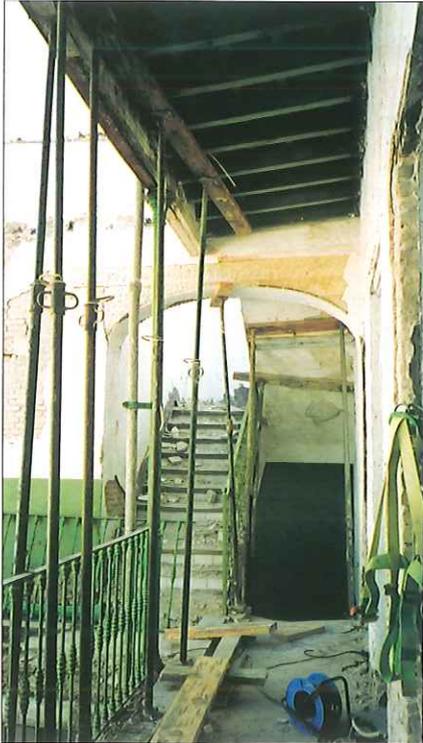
Detalle de apuntalamiento de la galería perimetral y de la zanca de escalera.
